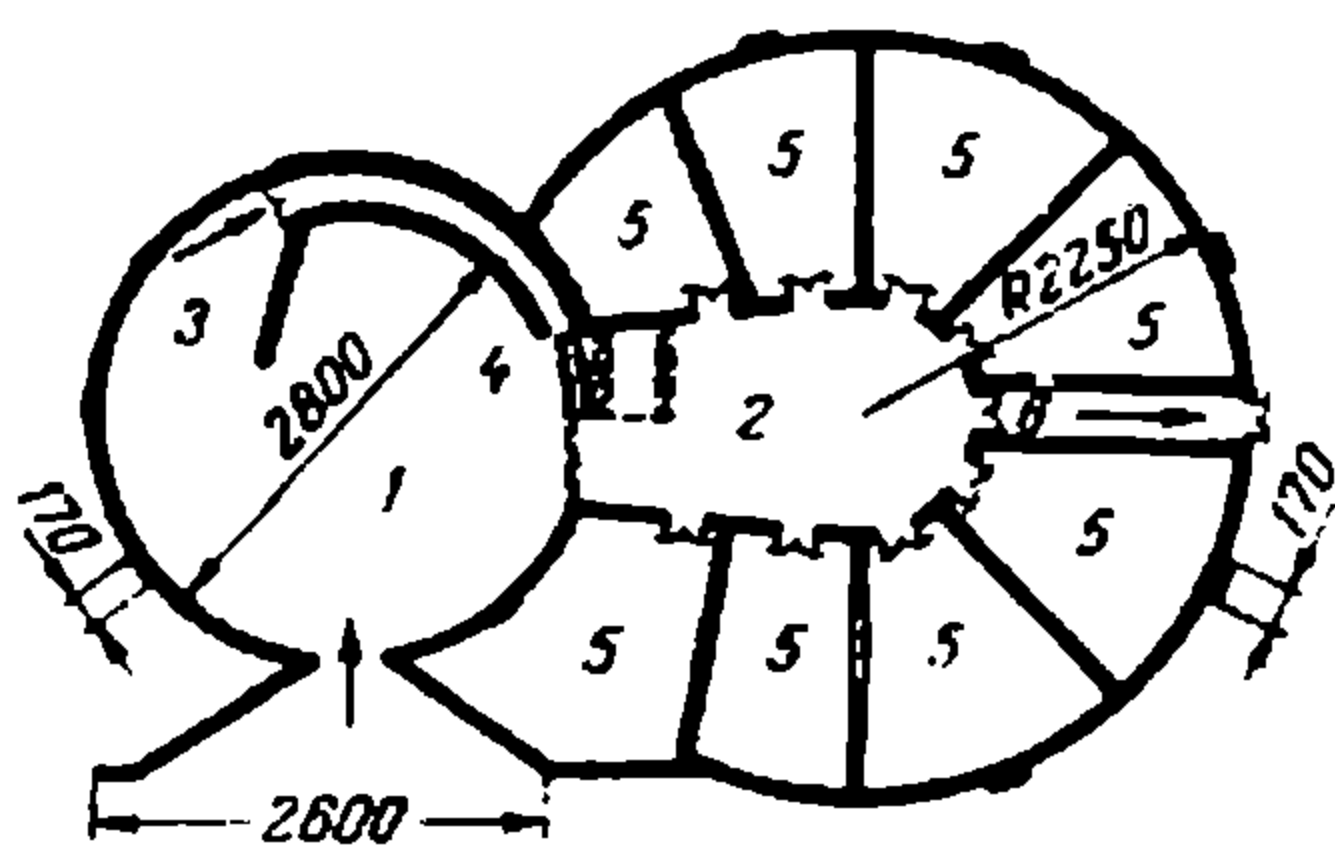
Розкольний баз для коней: 1 — приймальний баз; 2 — розподільний баз; 3 — воронка; 4 — розкольна клітка; 5 — секція розподільного базу; 6 — вихід.
